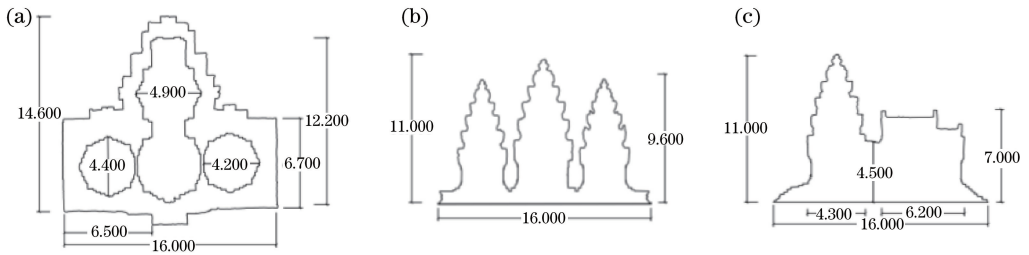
女王宫主建筑平立剖面图(单位:m)。(a)平面图;(b)立面图;(c)剖面图
